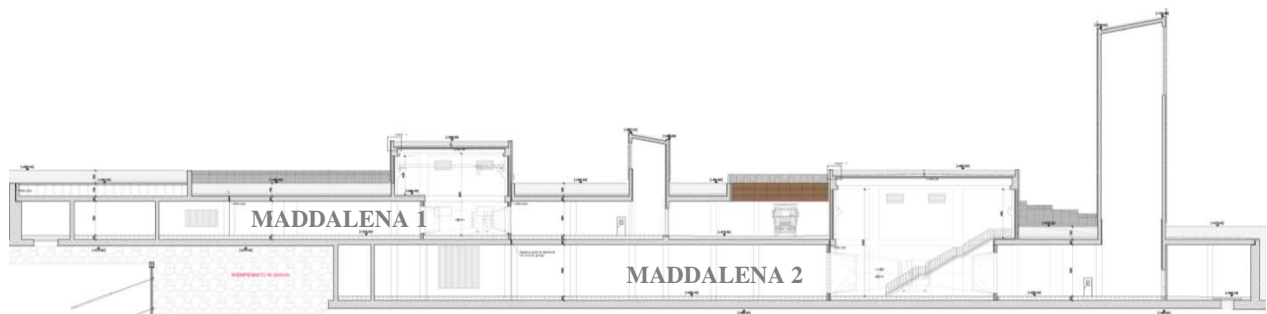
Sezione longitudinale della nuova centrale di ventilazione
